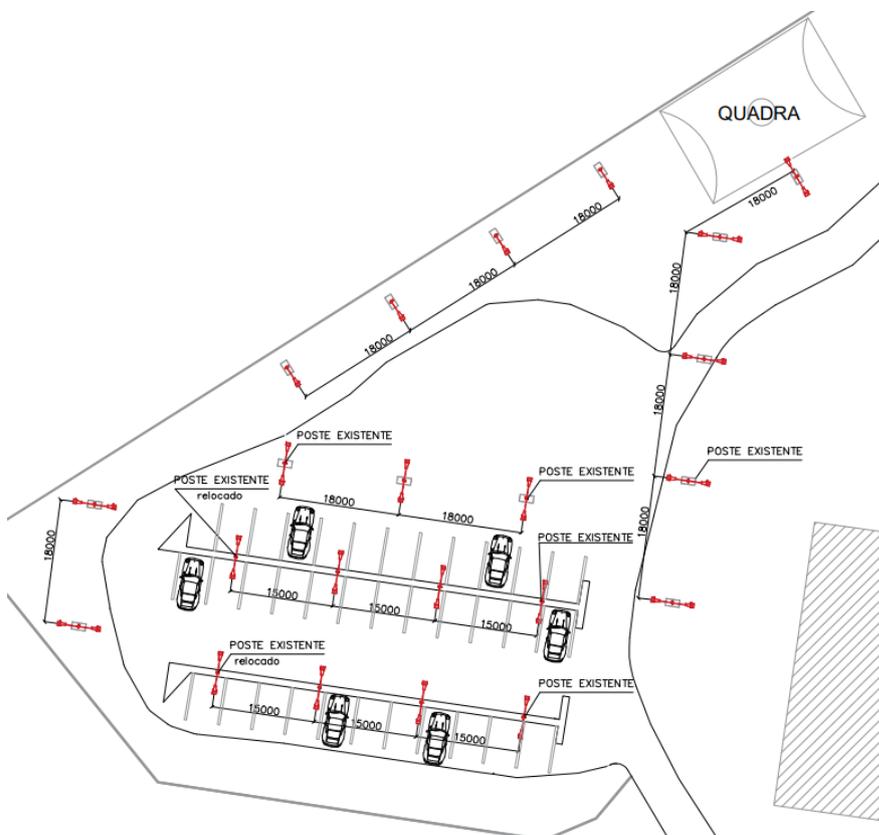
Planta baixa do posicionamento dos novos postes redimensionados.
